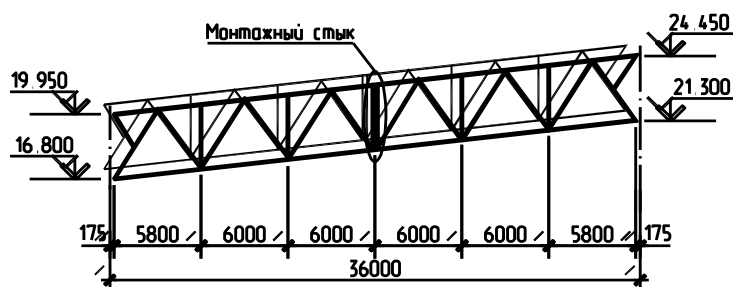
Схема фермы с габаритными размерами
